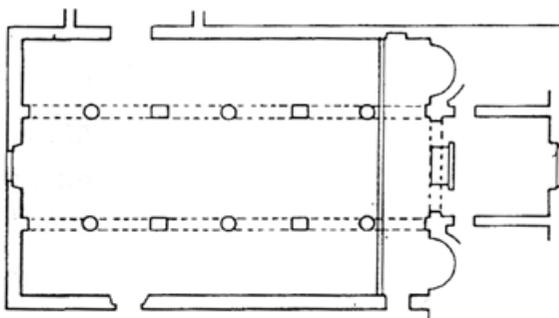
Pianta della pieve di Santa Maria Assunta a Fabbrica
